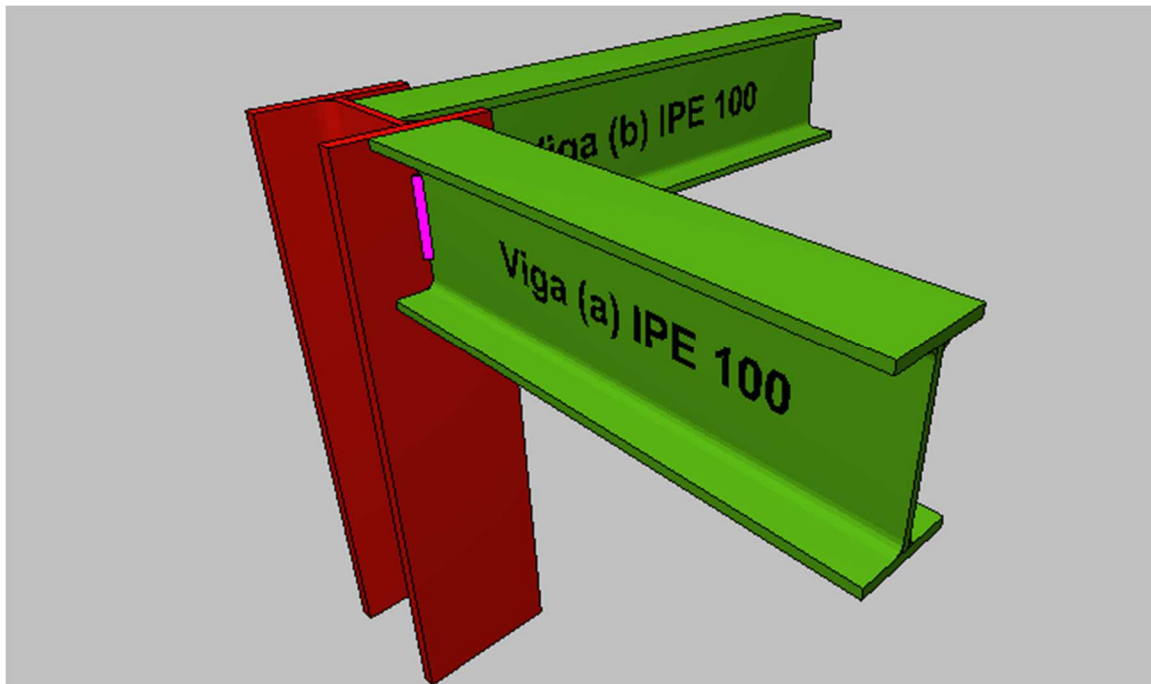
Unión tipo 4 escaleras. Viga-pilar-viga
